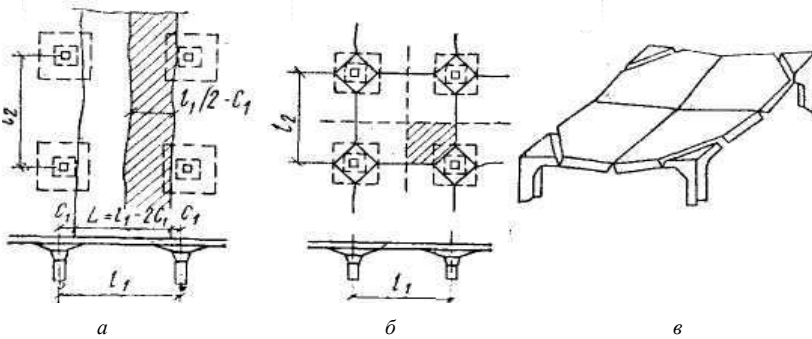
К расчету безбалочного перекрытия по методу предельного равновесия
